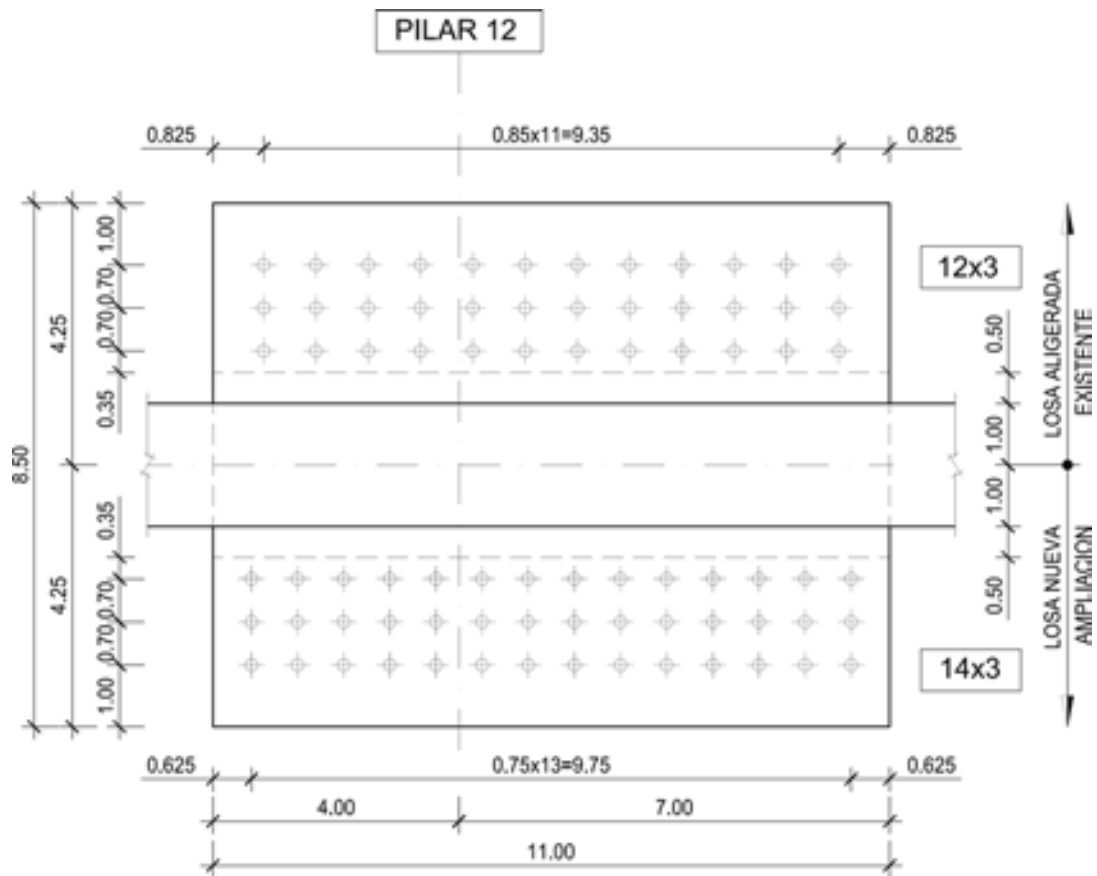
Esquema en planta con la ampliación de la cimentación existente
